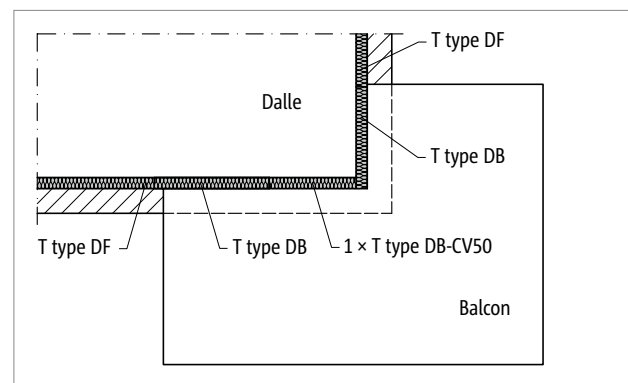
Schöck Rutherma® T type DB : balcon avec angle sortant en porte-à-faux et plancher constitué de prédalles
